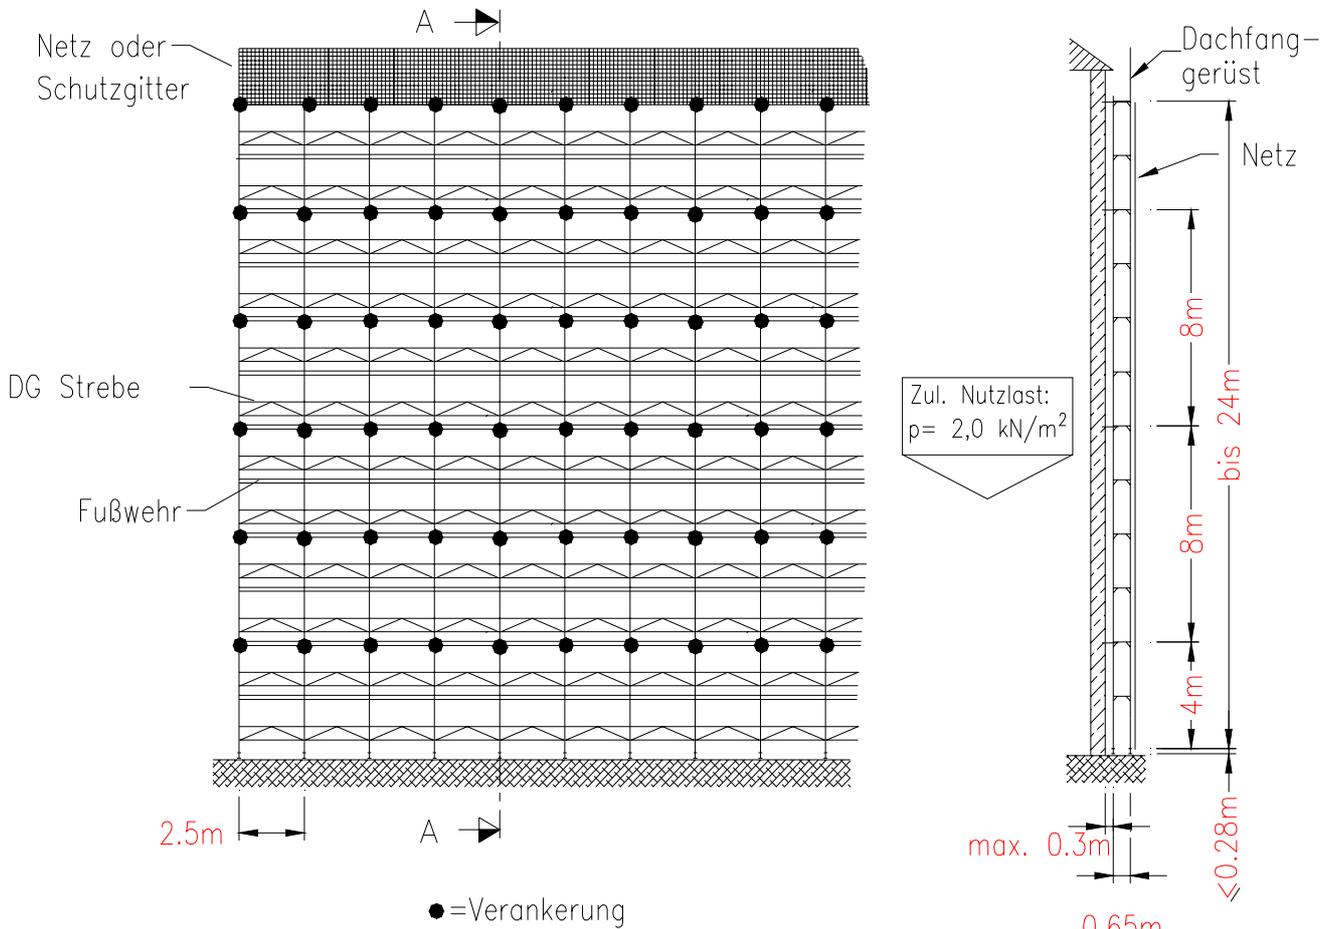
Netzbekleidete Konsolkonfiguration vor geschlossener Fassade
